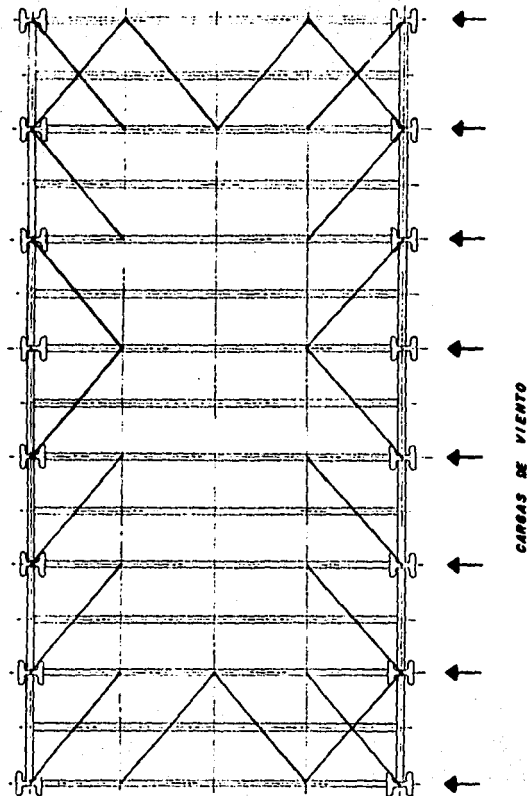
Funcionamiento simple de las armaduras de contraviento.
